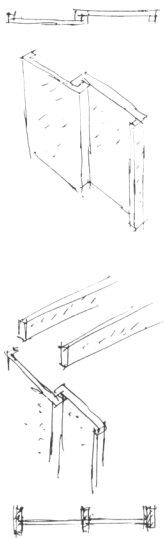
croquis do sistema construtivo em concreto armado desenvolvido por Oscar Niemeyer para os SGs.
